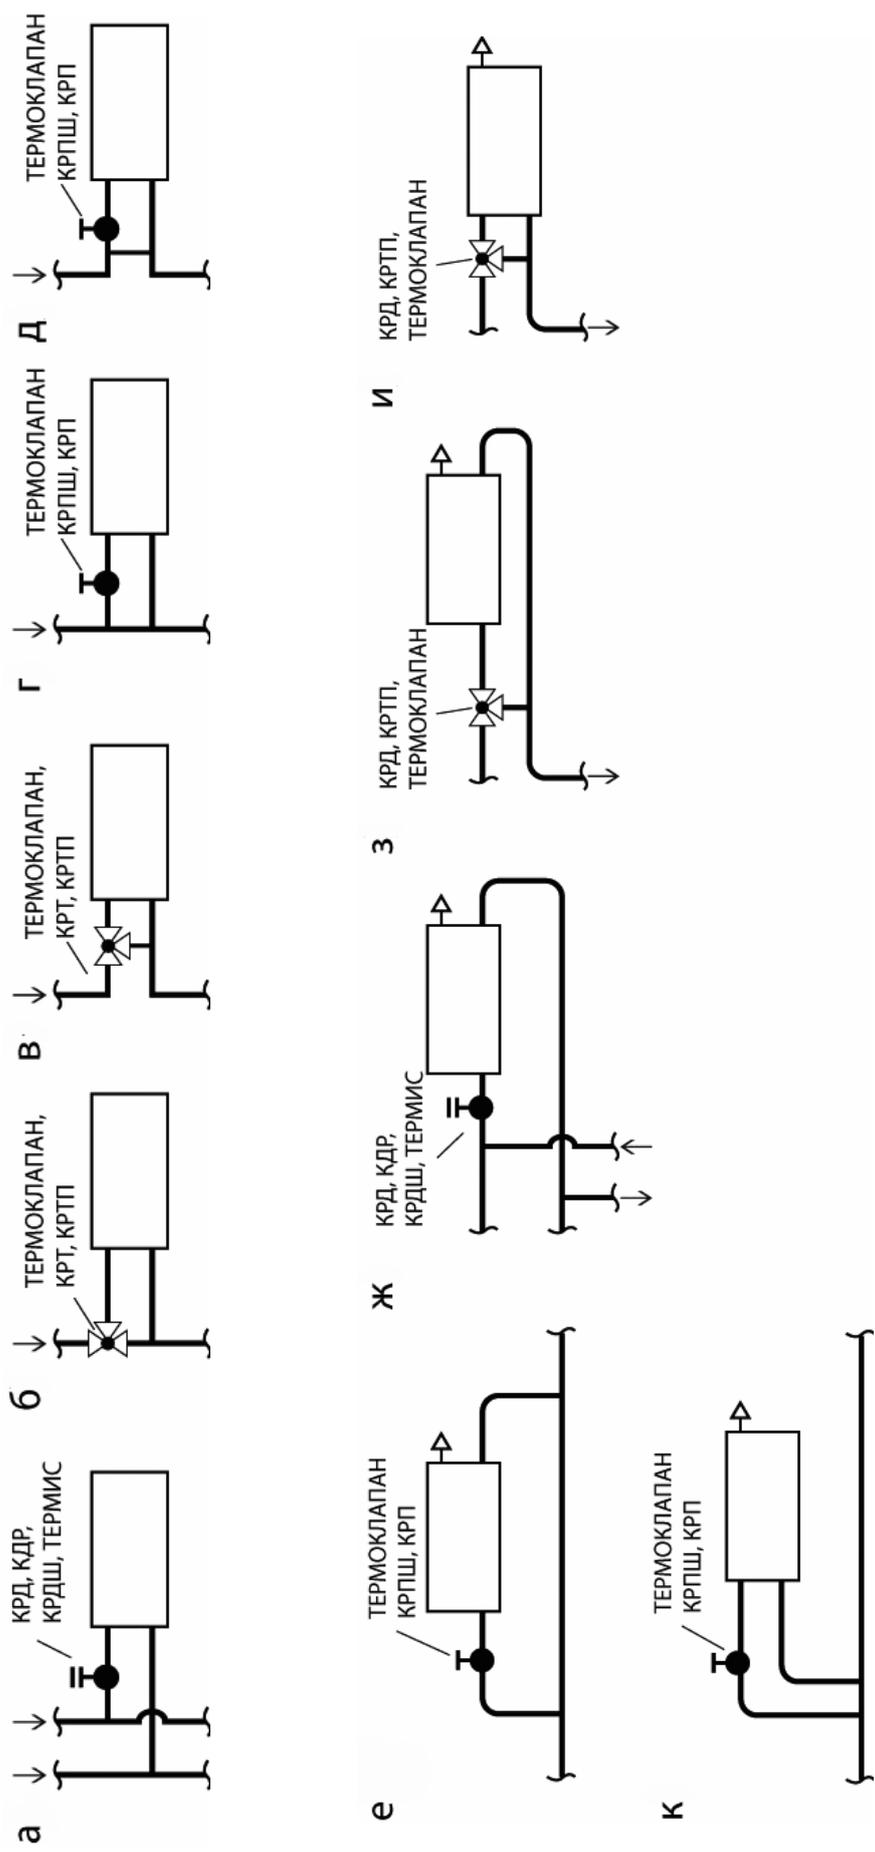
Схема установки запорно-регулирующей арматуры на подводках системы отопления:
